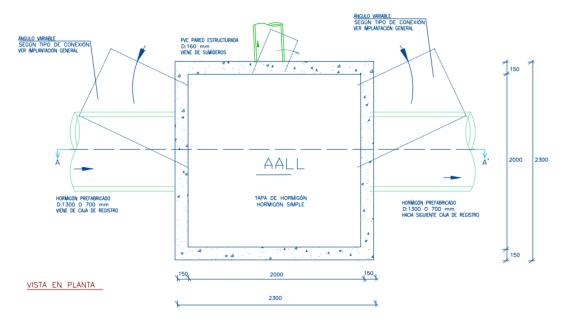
Caja de registro para tubería de concreto. Fuente: Elaboración propia
